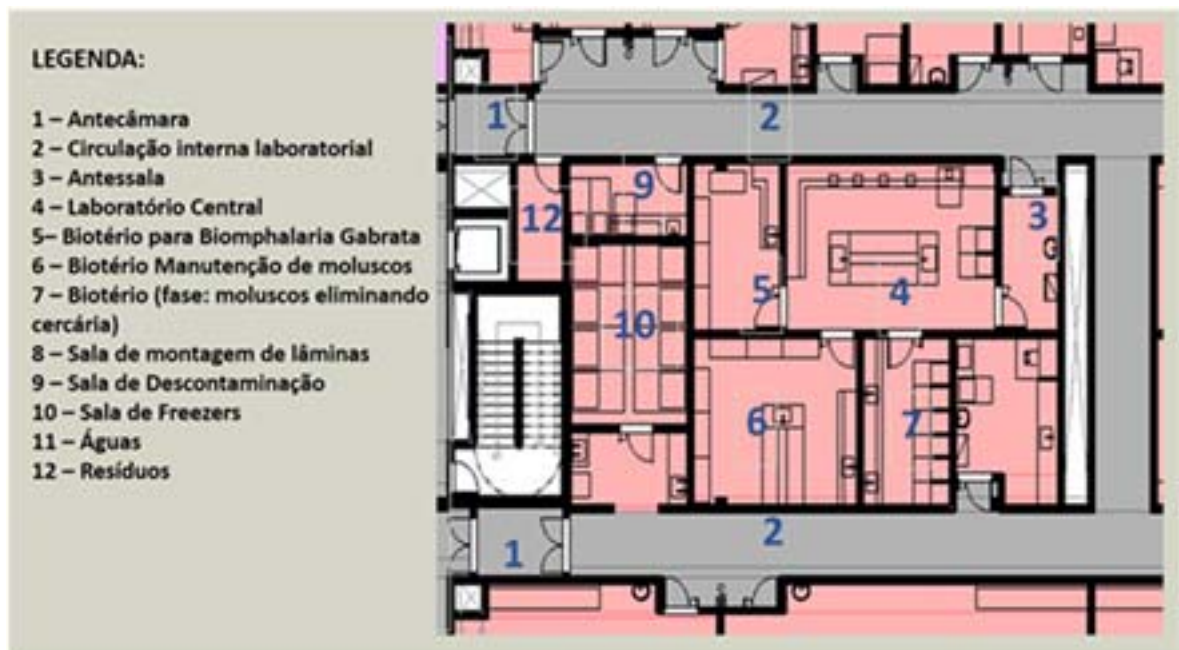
Planta baixa do terceiro pavimento do edifício principal. Nova sede da FIOCRUZ em Belo Horizonte, Brasil.
